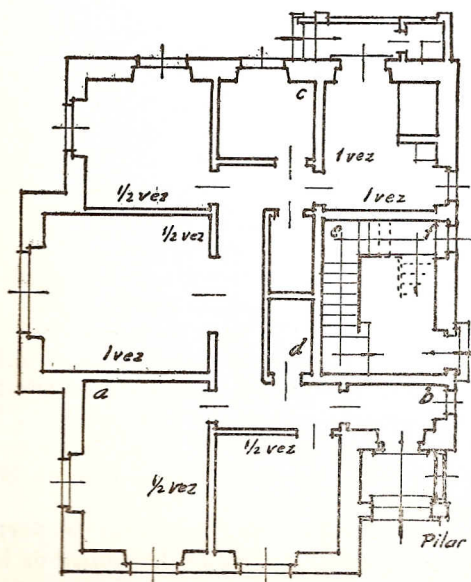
PIANTA DE UMA CASA INDEPENDENTE
